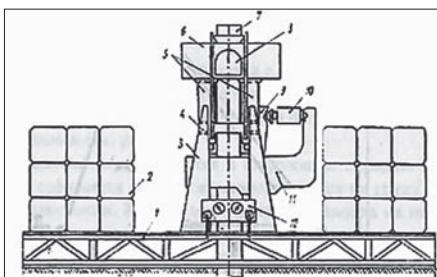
Схема несамостоятельной вдавливающей установки: 1 — пространственная балка грузовой платформы; 2 — съемный пригруз; 3 — кронштейн; 4 — палец; 5 — гидродомкрат для вдавливания свай; 6 и 11 — верхняя и нижняя балки рабочего органа установки (соответственно); 7 — свая; 8 — маслостанция; 9 — рычаг; 10 — гидродомкрат зажима свай; 12 — пульт управления
